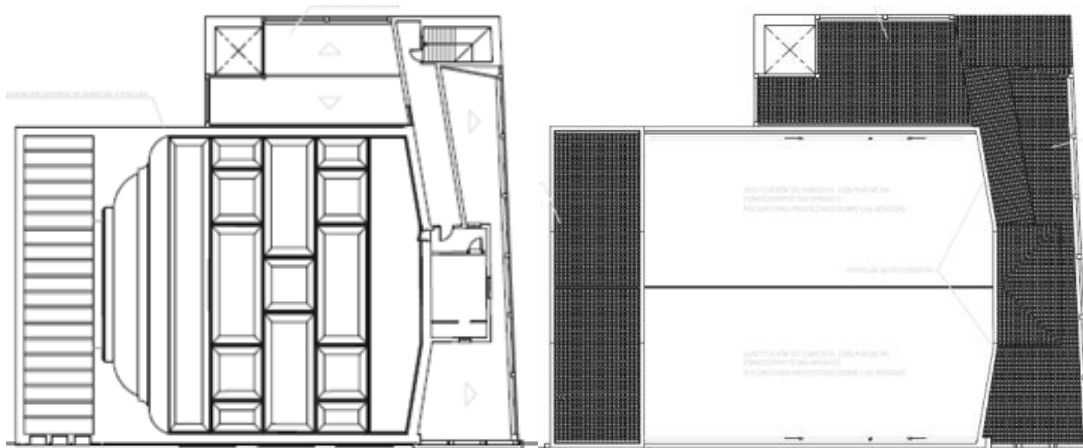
a 977. Plano de entresuelo sin reformar y reformado, planta alta y camerinos (MARAVER, J.F., ÁLVAREZ, F.J., 1993).
